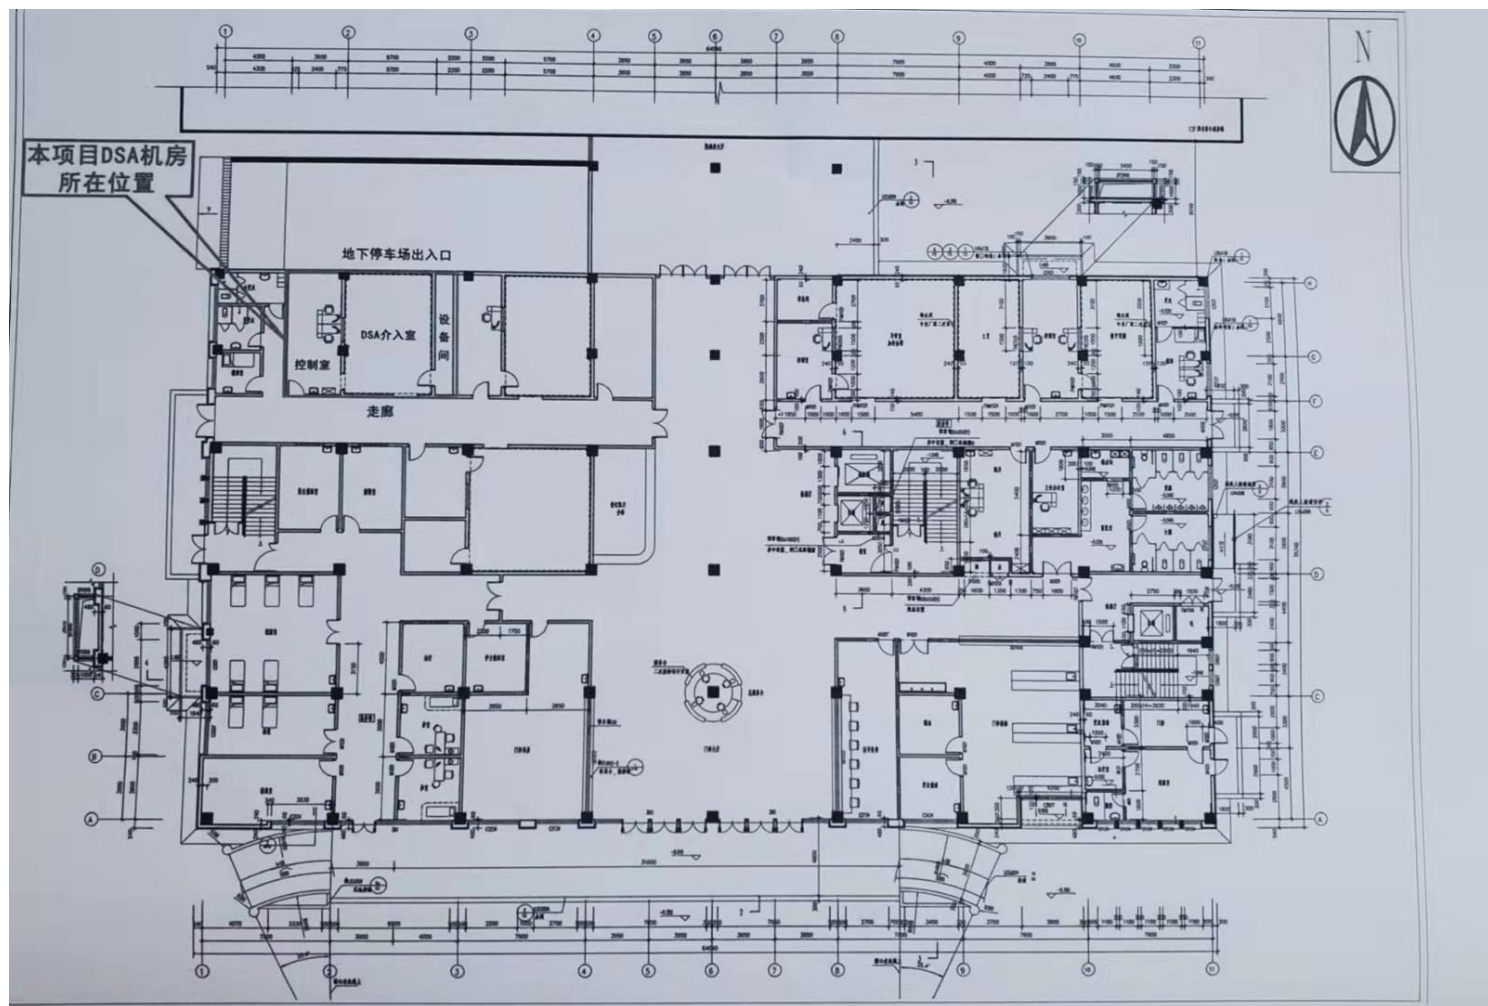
DSA 所在楼层（门诊楼一楼）平面布置示意图
